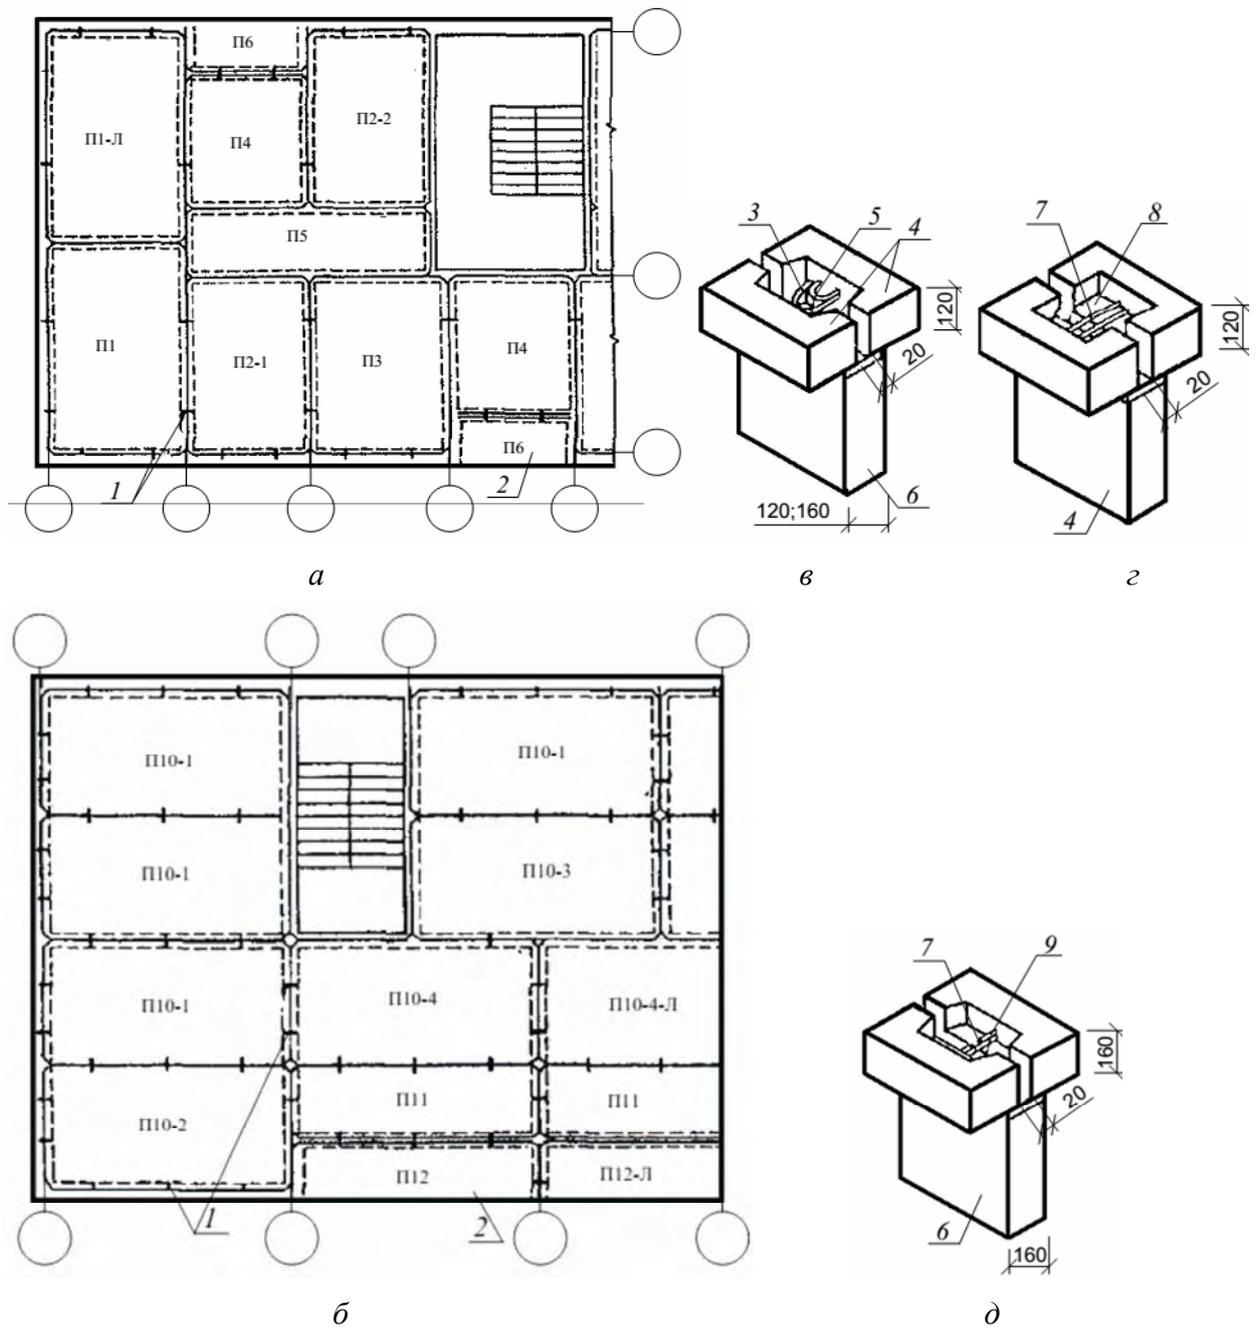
Опираие панелей перекрытия сплошного сечения на стены: монтажные схемы перекрытия при малом (*а*) и большом шаге стен (*б*); *в* — стык и крепление панелей перекрытия сваркой петель между собой при опирании на внутренние стены; *г, д* — то же с помощью соединительных стержней: 1 — сварные крепления; 2 — лоджии; 3 — разрезная монтажная петля; 4 — петли перекрытия; 5 — монтажная петля; 6 — панель внутренней стены; 7 — соединительный стержень; 8 — уголок; 9 — арматурный выпуск
